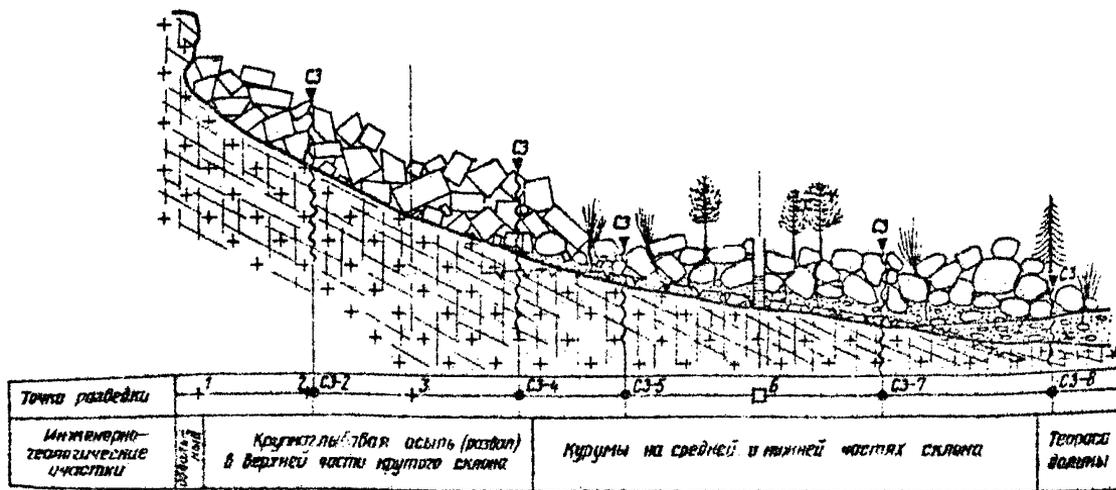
Примерная схема разведки склона, покрытого глыбовыми осыпями и курумами, с помощью сейсморазведки и редких опорных выработок и обнажений.
